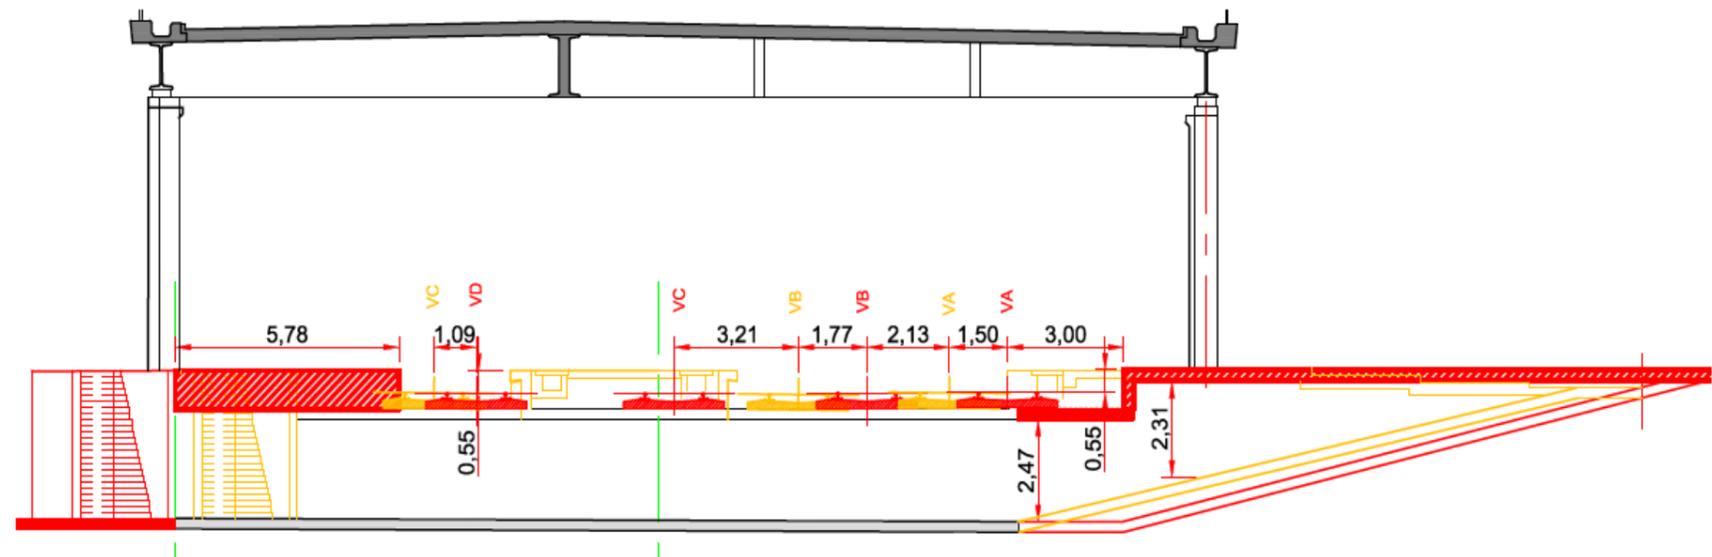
Coupe du passage Gambetta (Systra, 2021)
